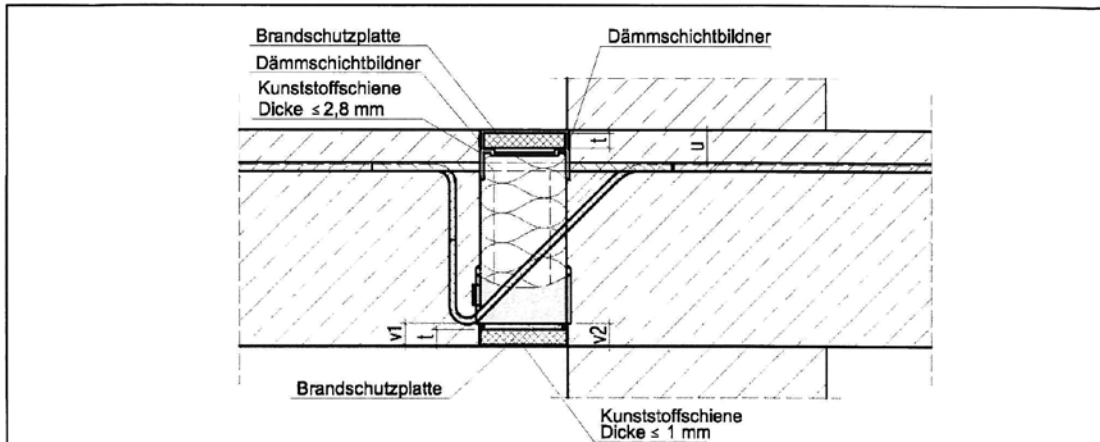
Schöck Isokorb Typ K und Typ KF (Ausführungsvariante A) gem. Abschnitt 2.1.3
